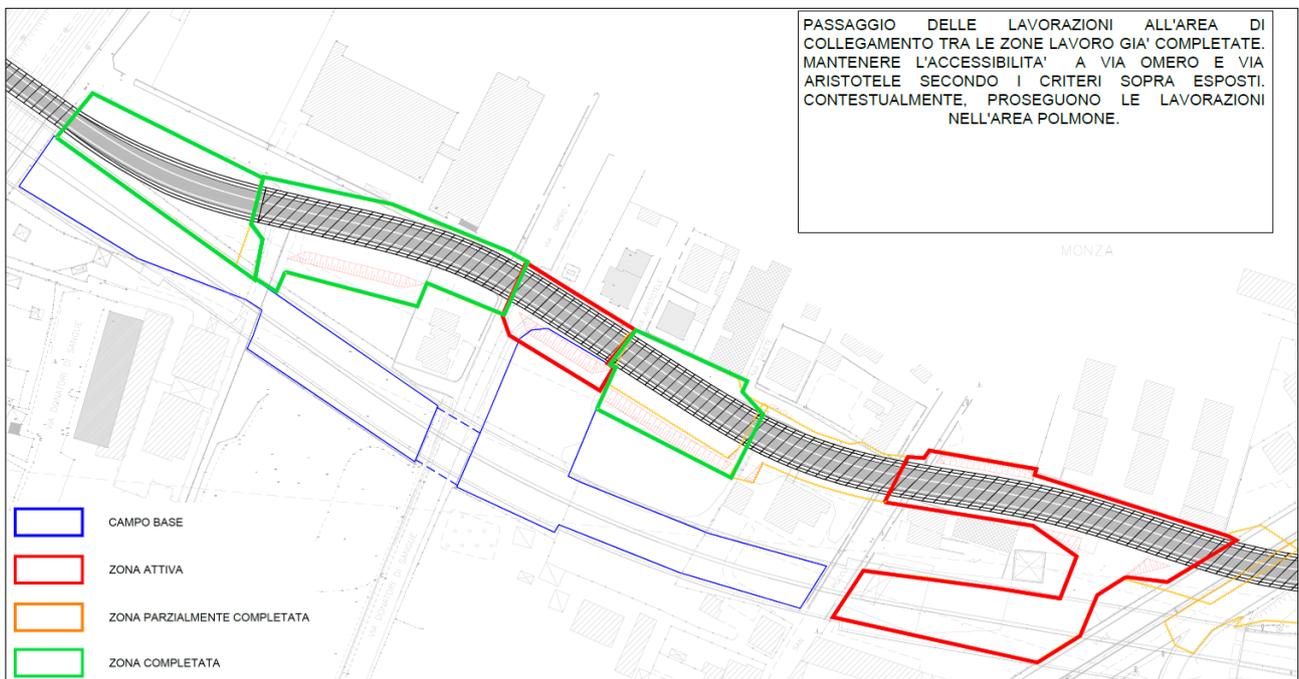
Fasi realizzazione copertura galleria del Piano di Sicurezza di progetto illustrativo della fase D di scavo della galleria.
